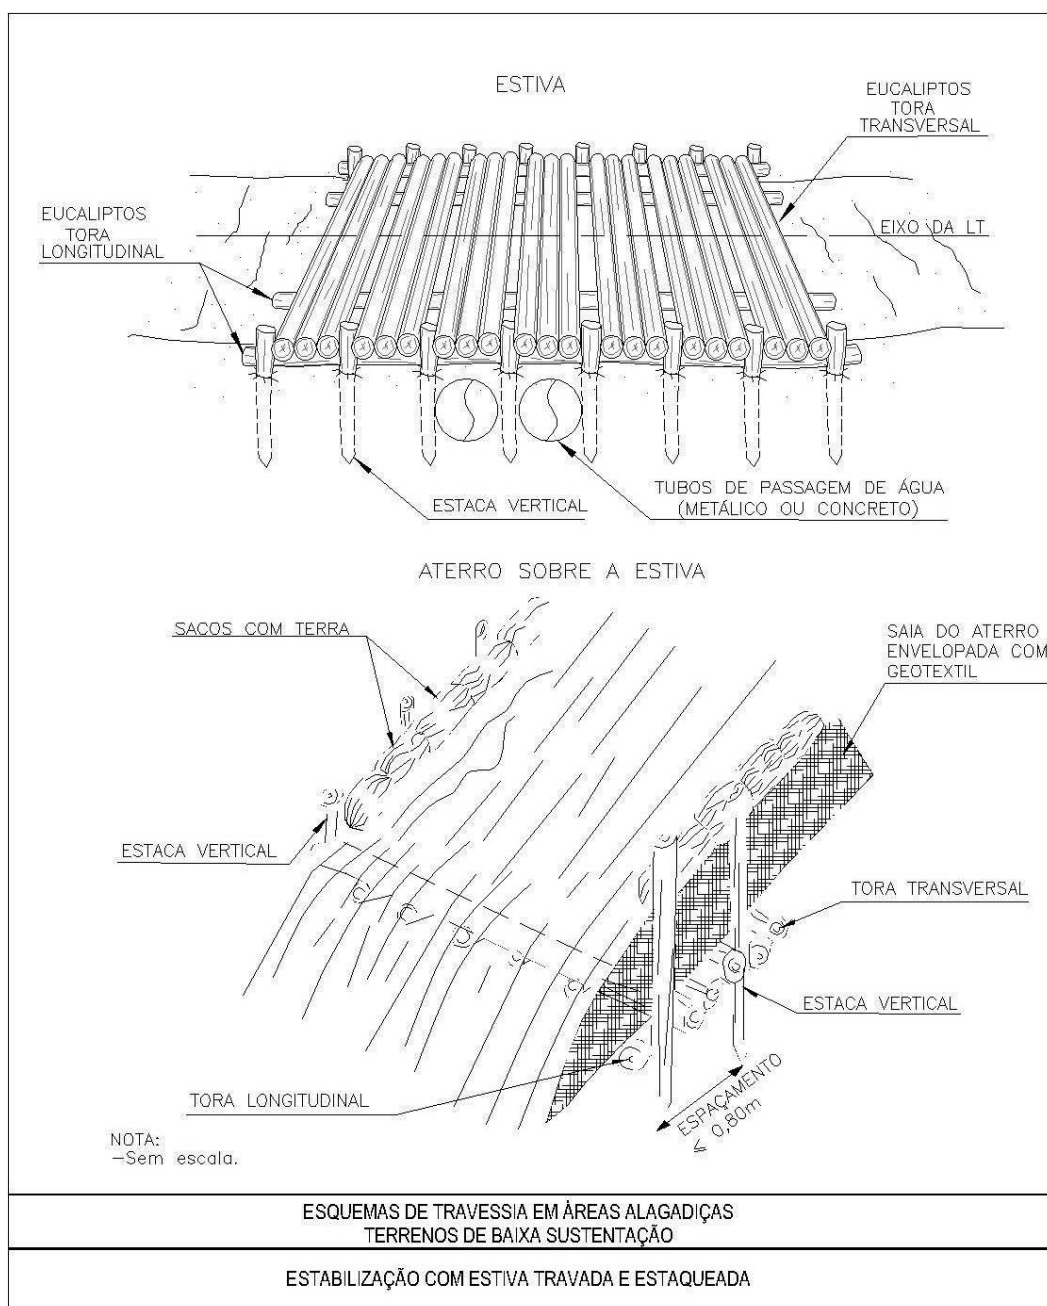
Construção em áreas de várzea em terrenos de baixa sustentação.
